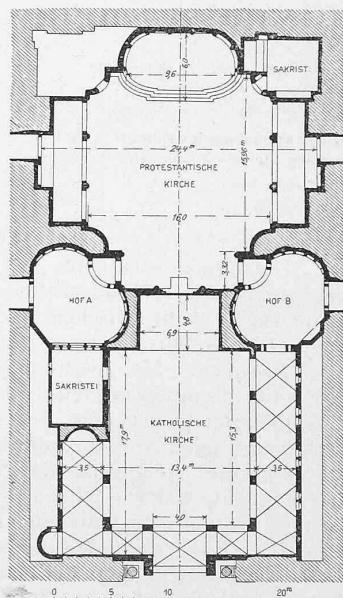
Grundriss der kirchlichen Ausstellung. — Maßstab 1 : 600.
